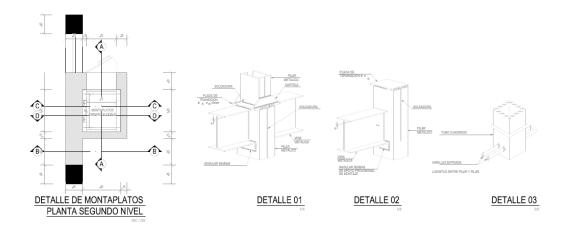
Detalle de sistema de montaplatos, (detalle en expediente de planos anexo a esta tesis).
